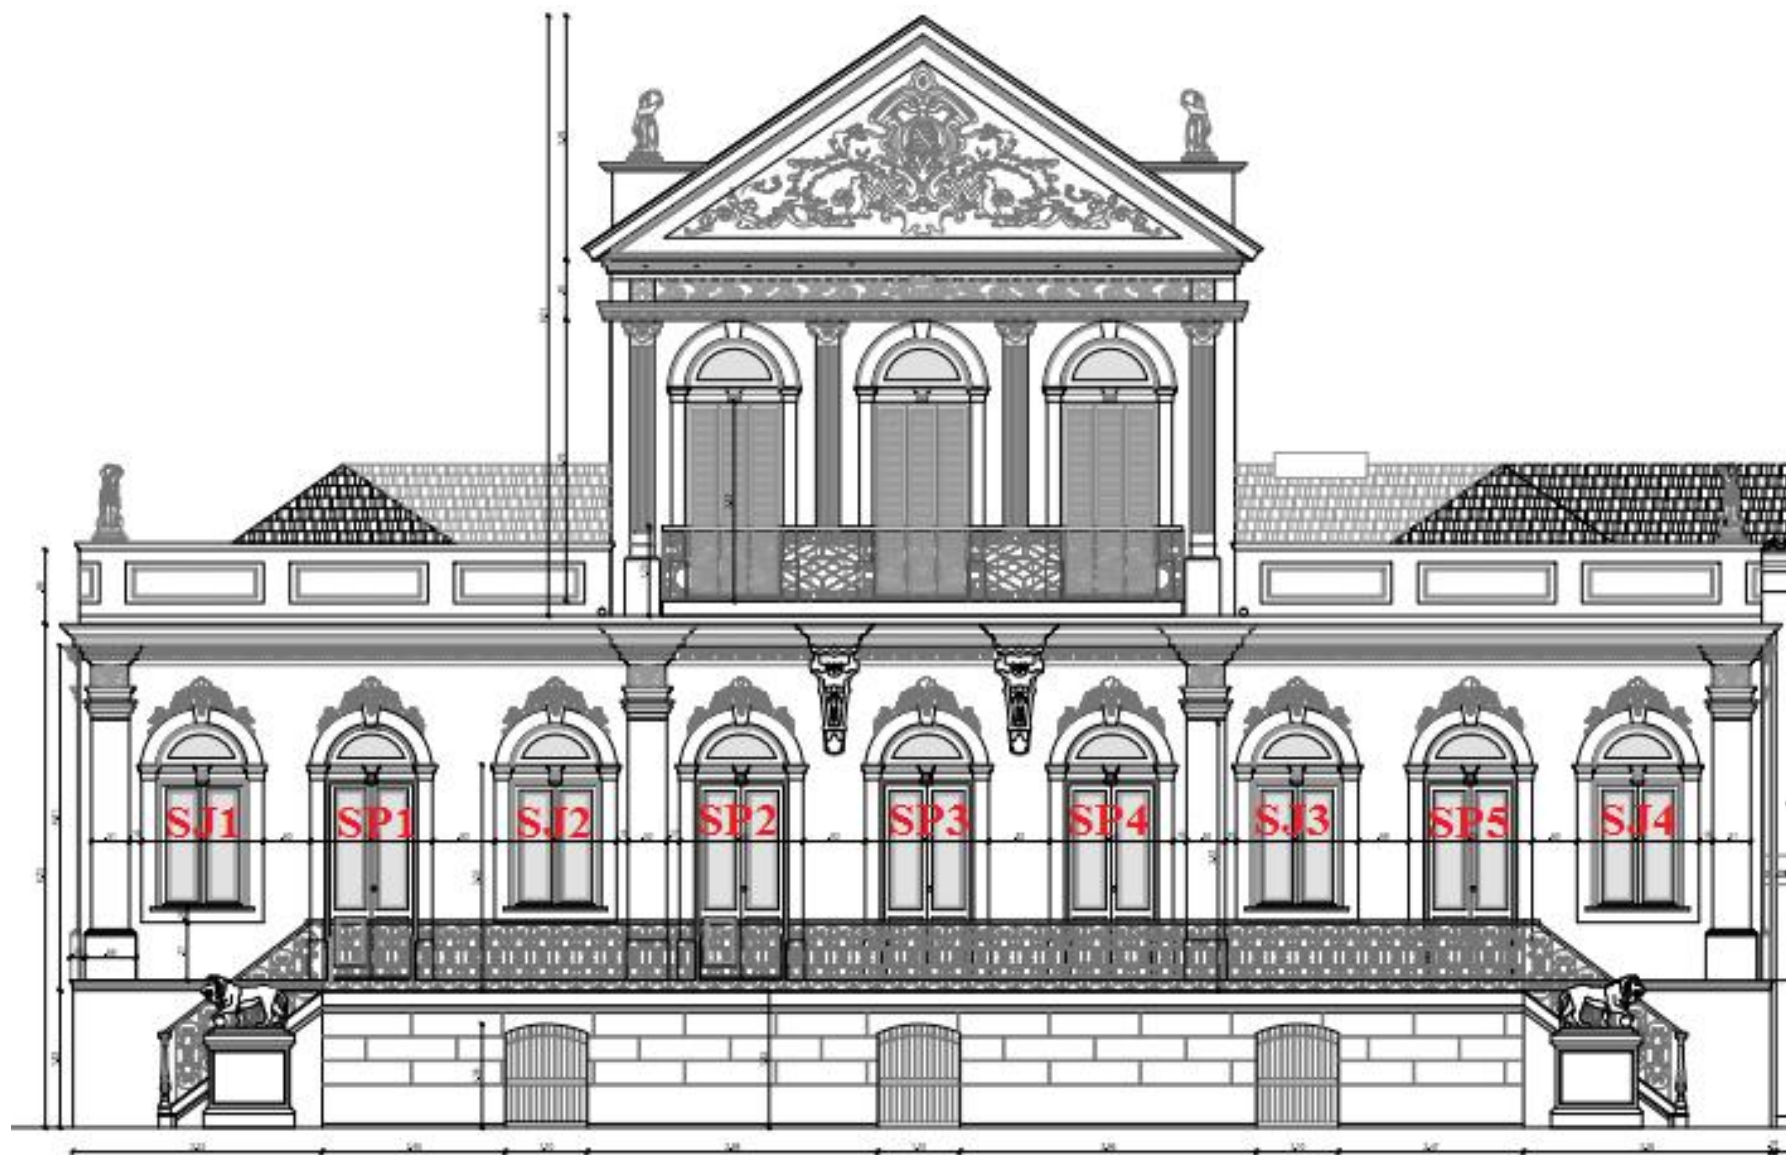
Planta da fachada sul principal com as suas portas e janelas nomeadas. Fonte: modificado de NPArq (2015).
